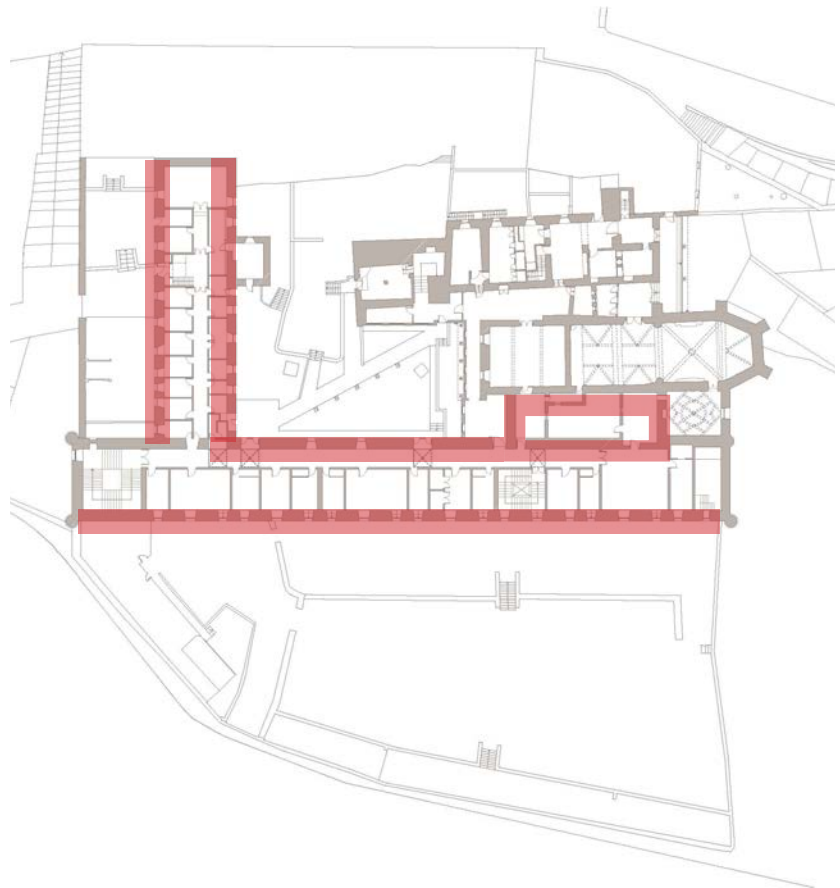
Situación de los mechinales en planta. Elaboración propia
